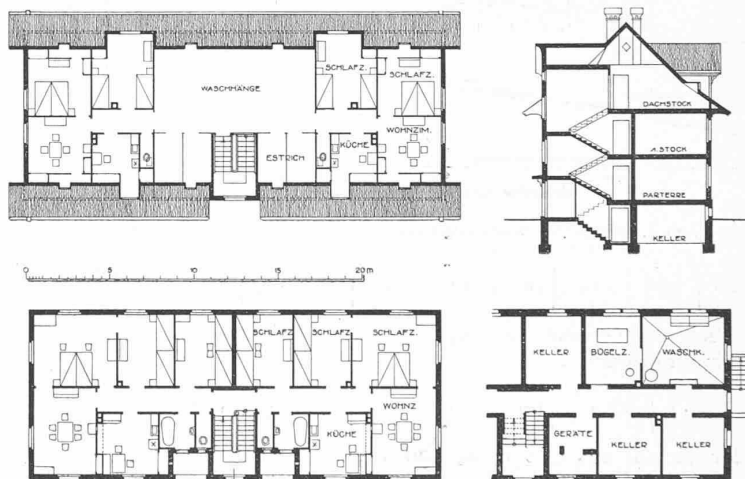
bis 6 Grundrisse, Abb. 7 Schnitt zum Beamtenwohnhaus. — Masstab 1:400.
